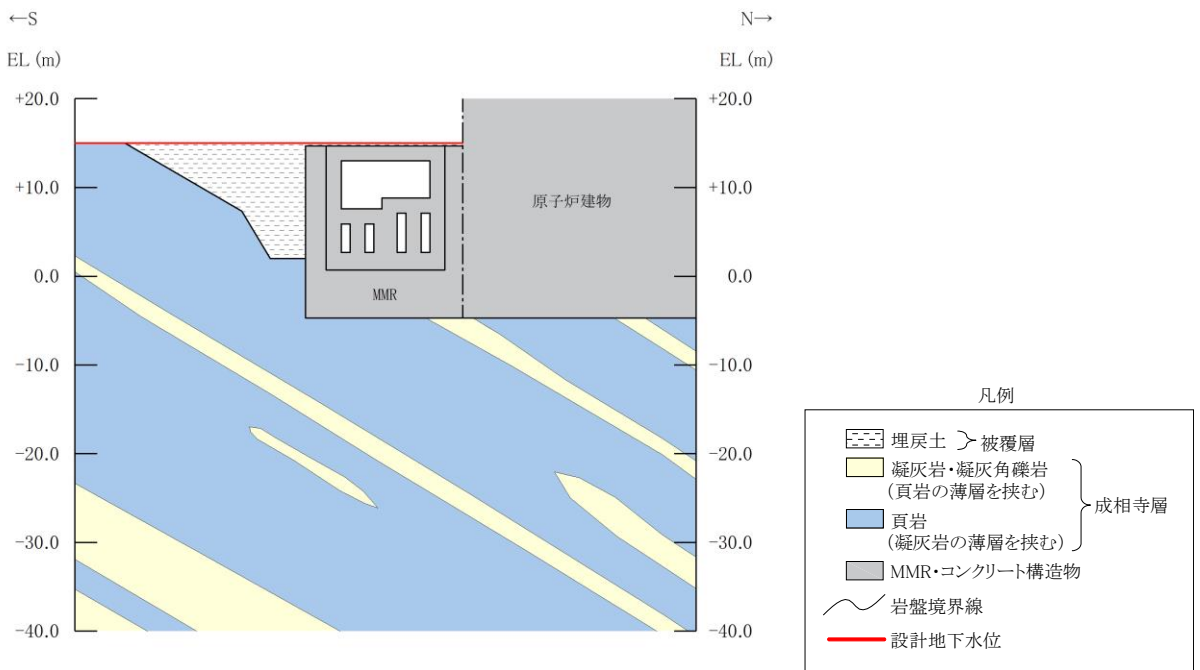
第 1 ベントフィルタ格納槽 評価対象断面図 (B-B 断面)
